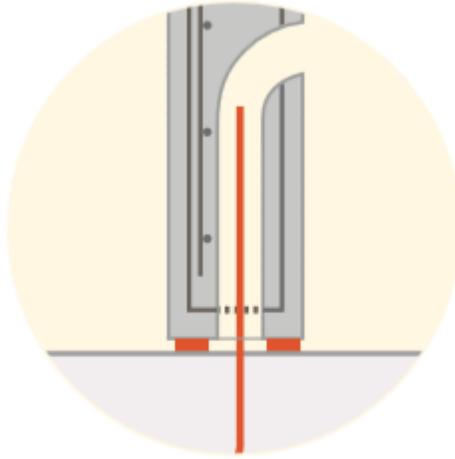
Unión Muro - Radier Fuente: Baumax
